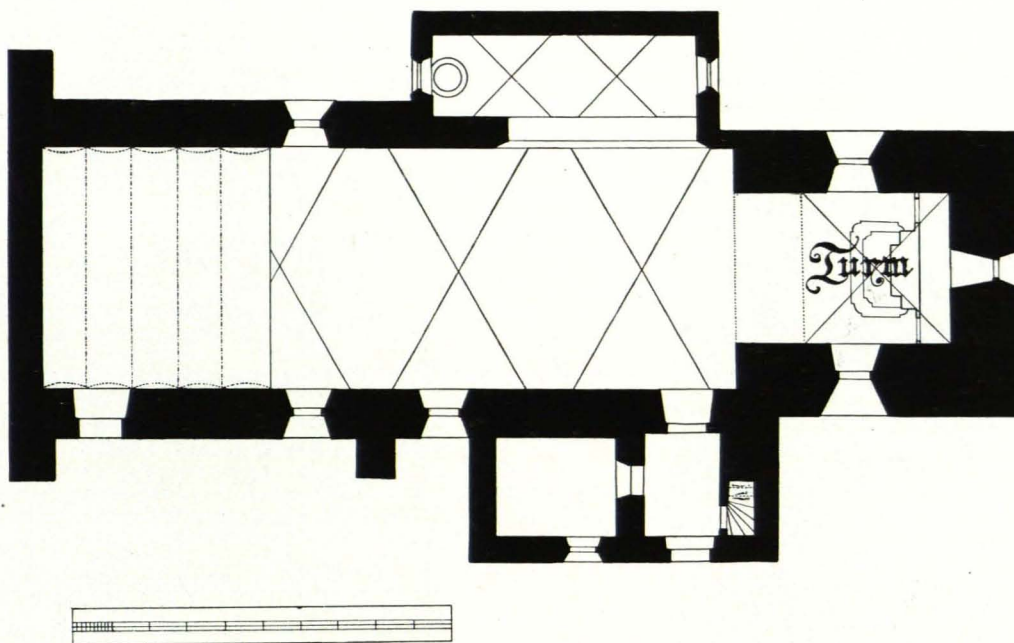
Sallingberg, Pfarrkirche, Grundriß 1:200 (S. 203)
